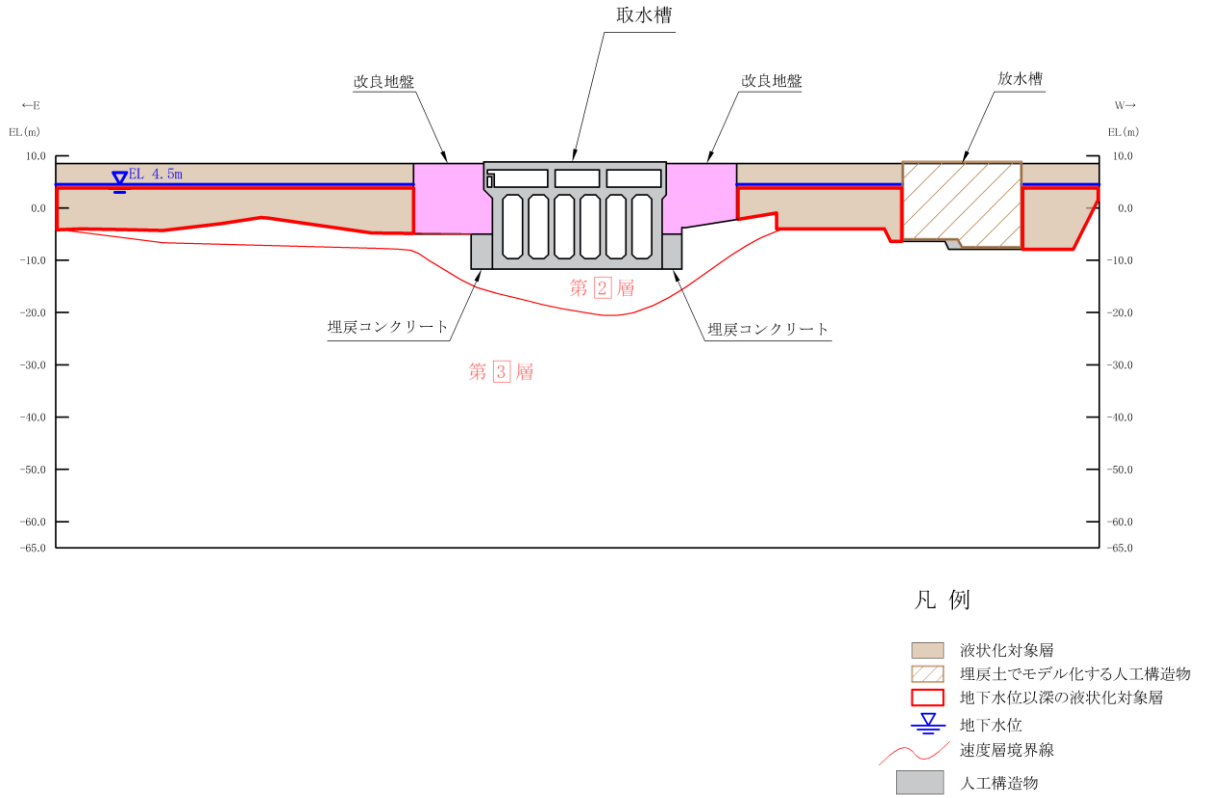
取水槽 地震時荷重算出断面図 (A-A 断面)
